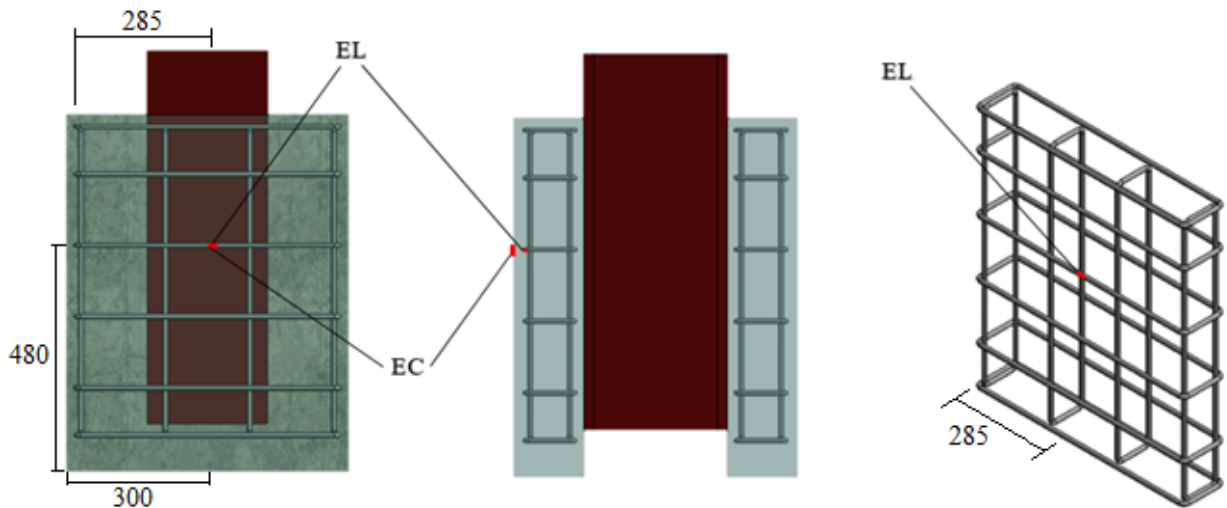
Posicionamento dos EER's. na armadura das lajes
